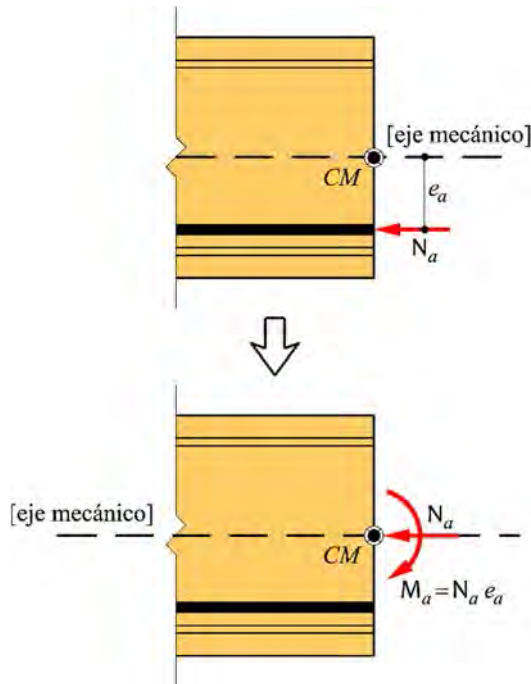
Reducción al centro mecánico de la sección transversal del esfuerzo axil en el tendón.
